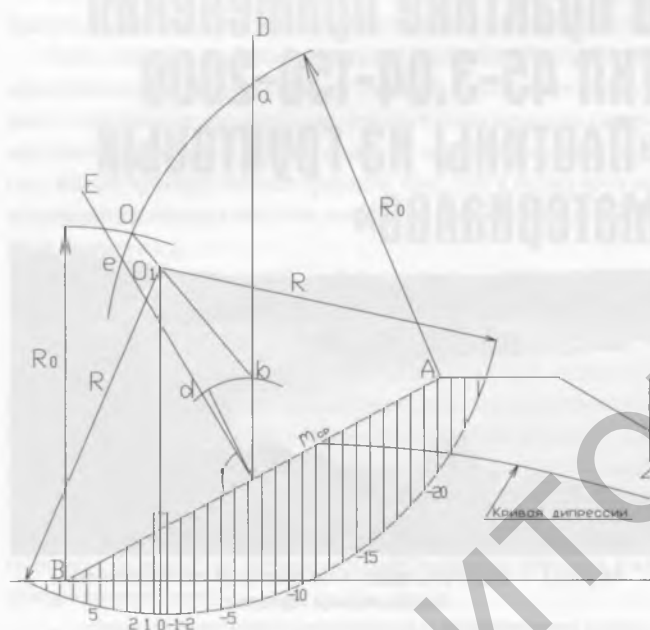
Схема к определению устойчивости верхового откоса грунтовой плотины
